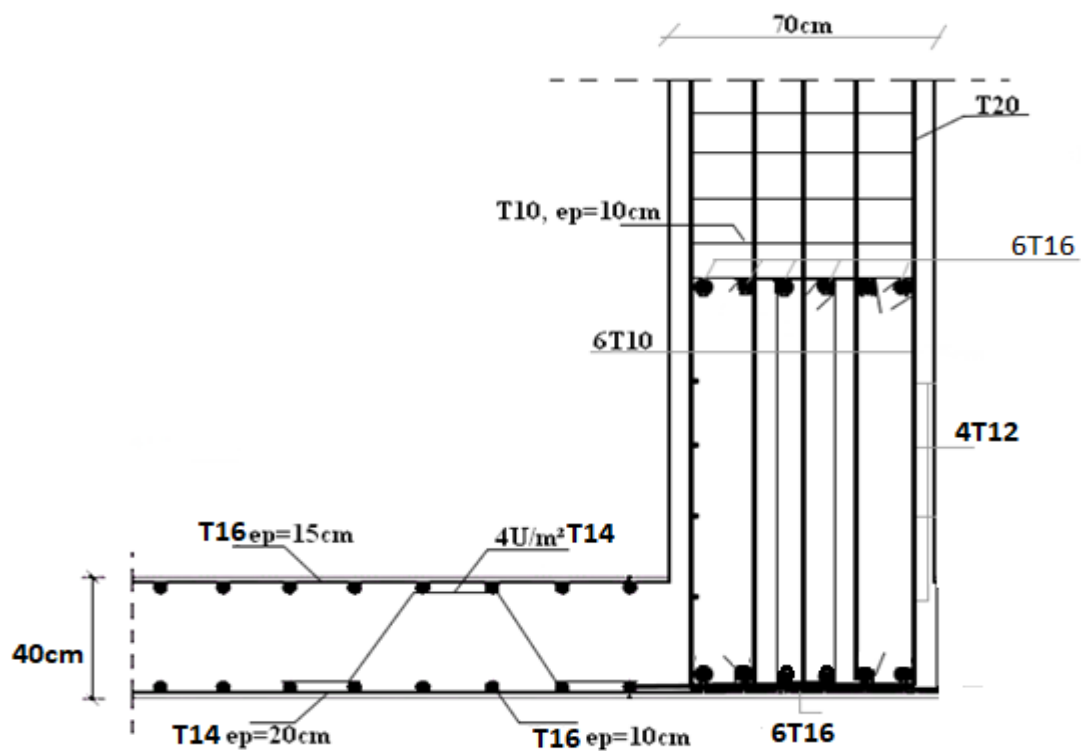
Ferrailage du radier, nervure, poteau sur une coupe en appui.
